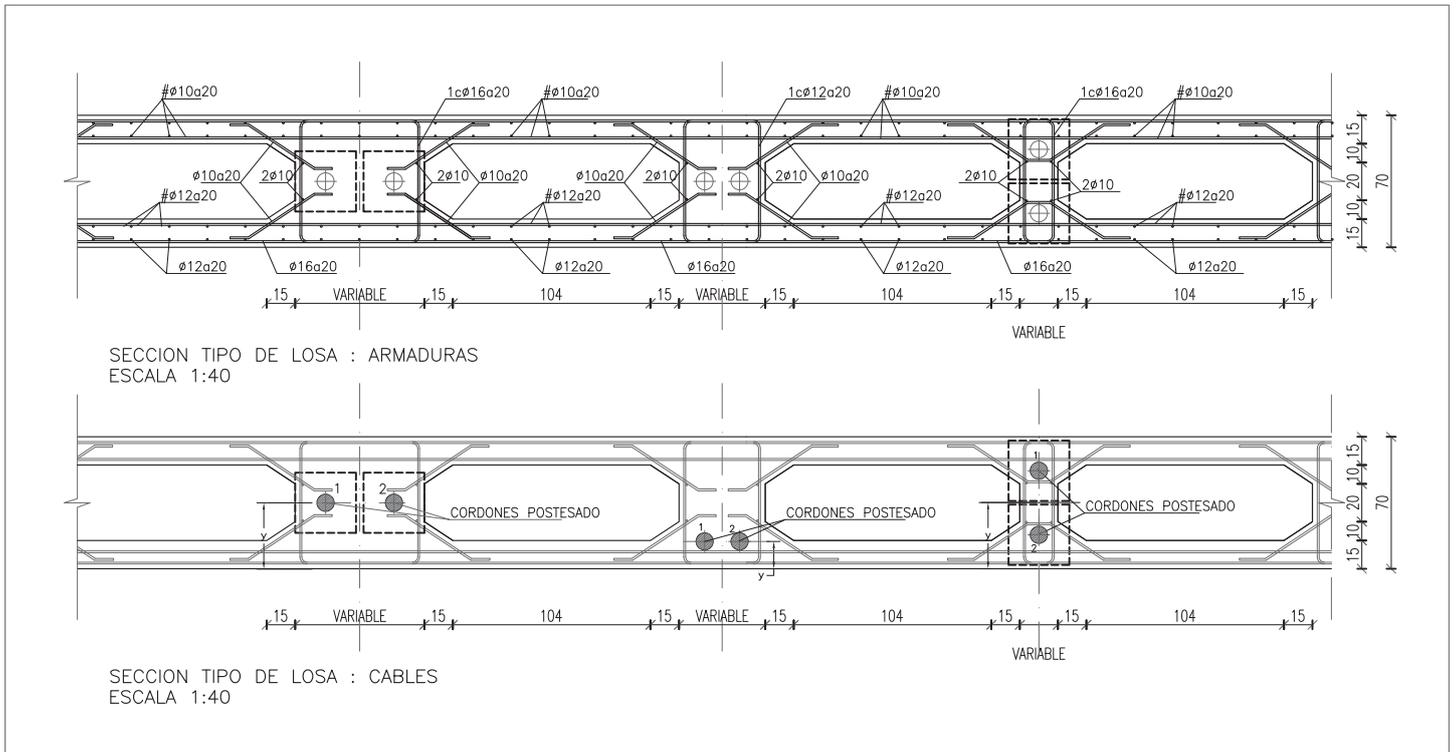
Detalle de la sección de la losa 1:40 [27]
